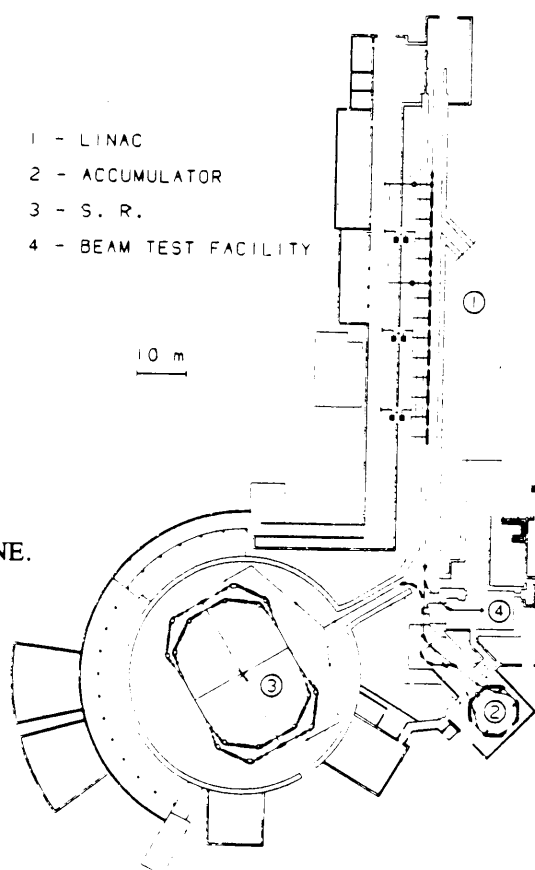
Planimetria d'insieme del complesso DAΦNE.
